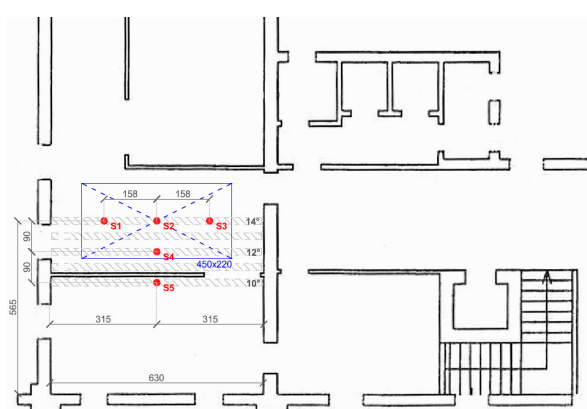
prova n°5 (Barchessa di levante, solaio 1° piano).
